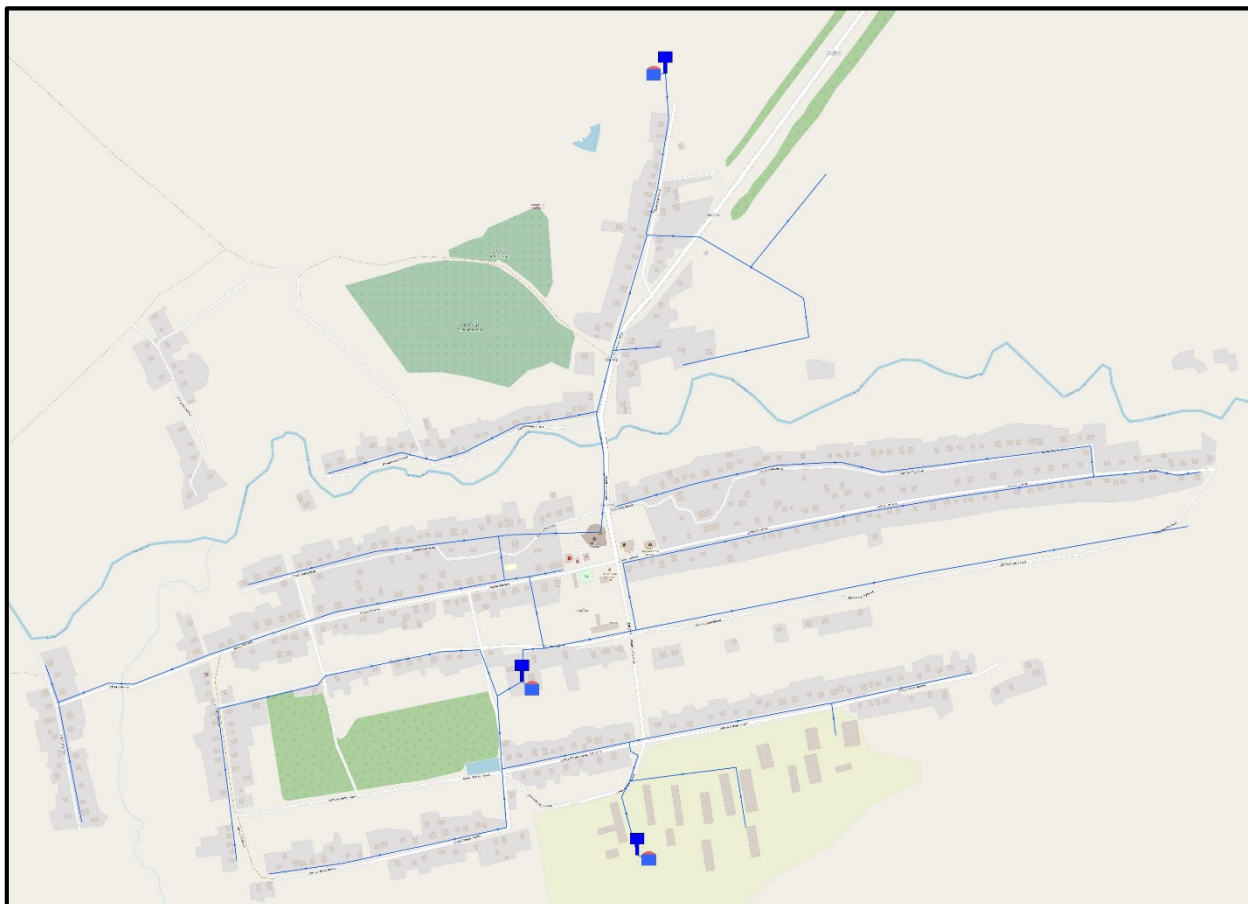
Схема водоснабжения с. Медяна
